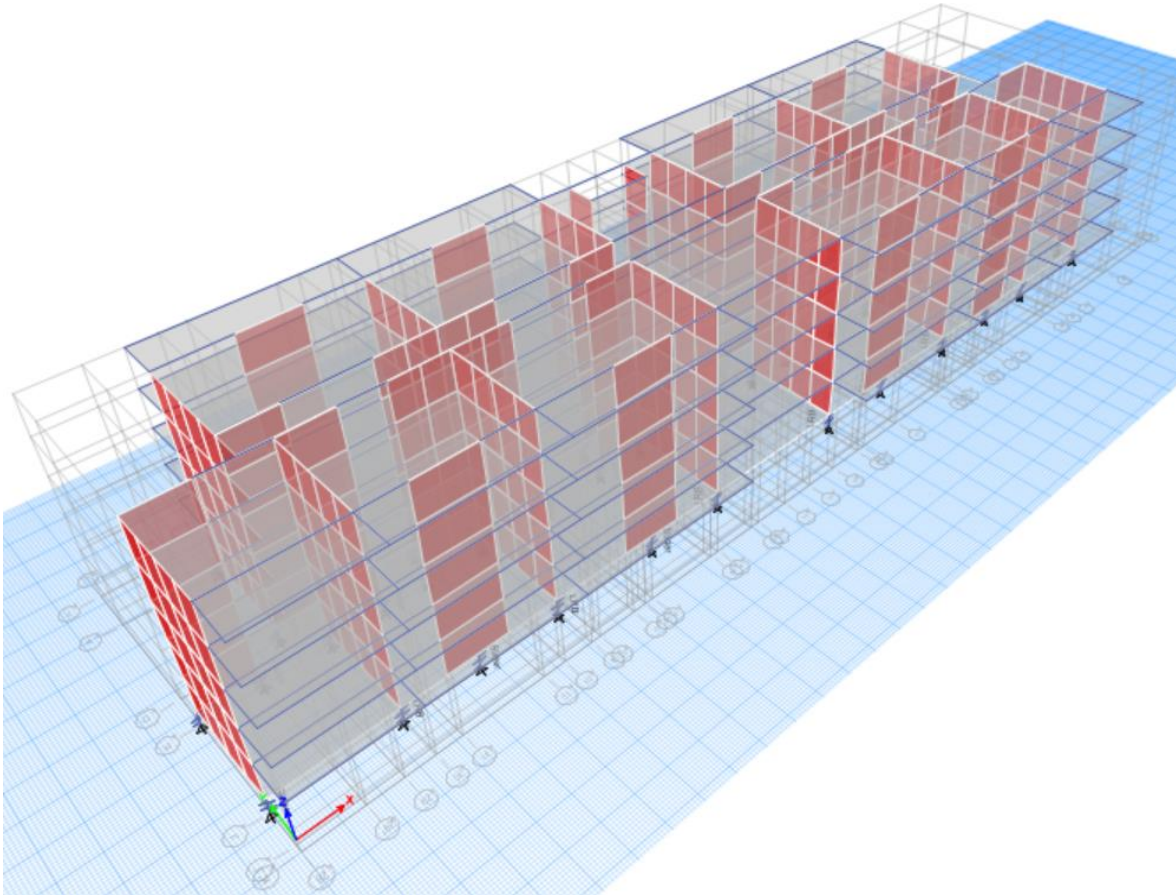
Modelo tridimensional estructura aislada con dispositivos LRB
